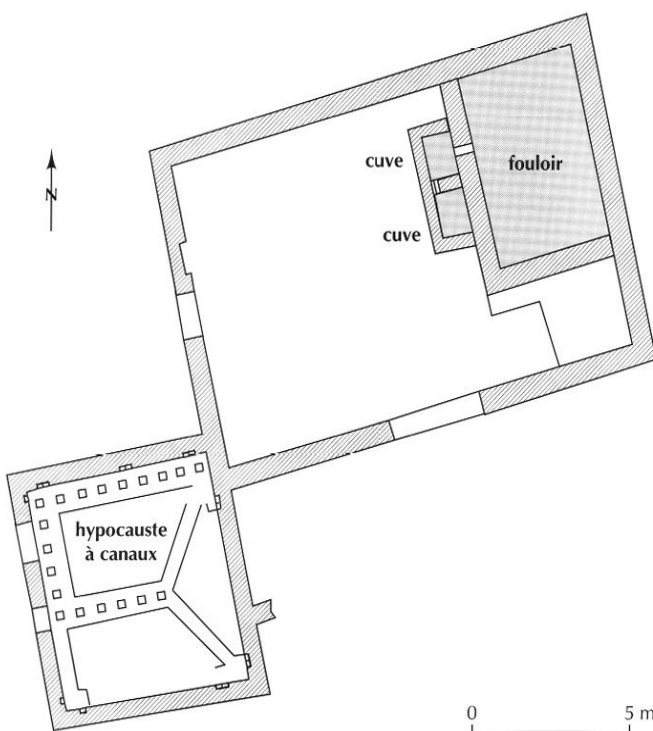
Plan du chai d'Im Dellert Est à Erden (d'après Gilles, 1999).
